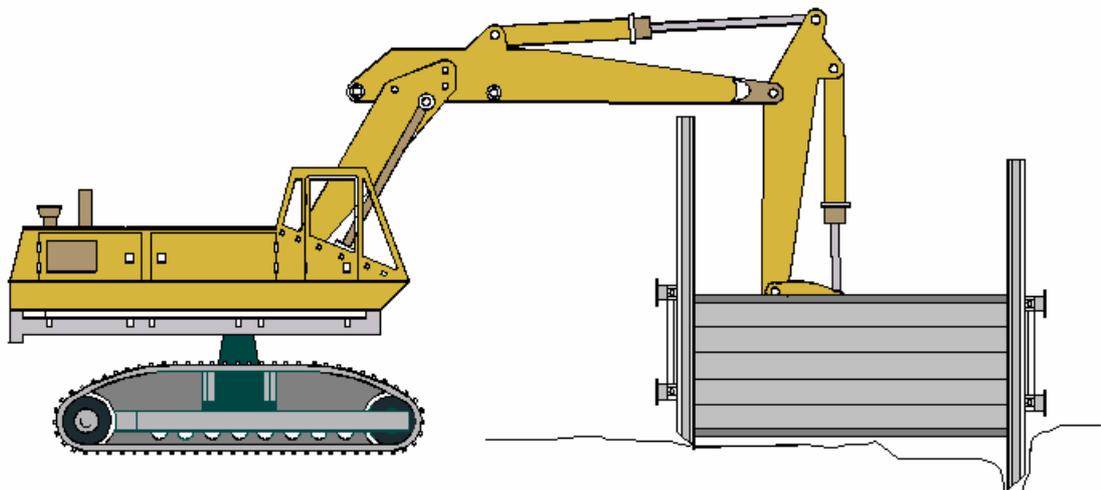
Excavación en el interior del primer modulo para realizar la colocación del primer modulo dentro de la excavación final./Elaboración Propia.
